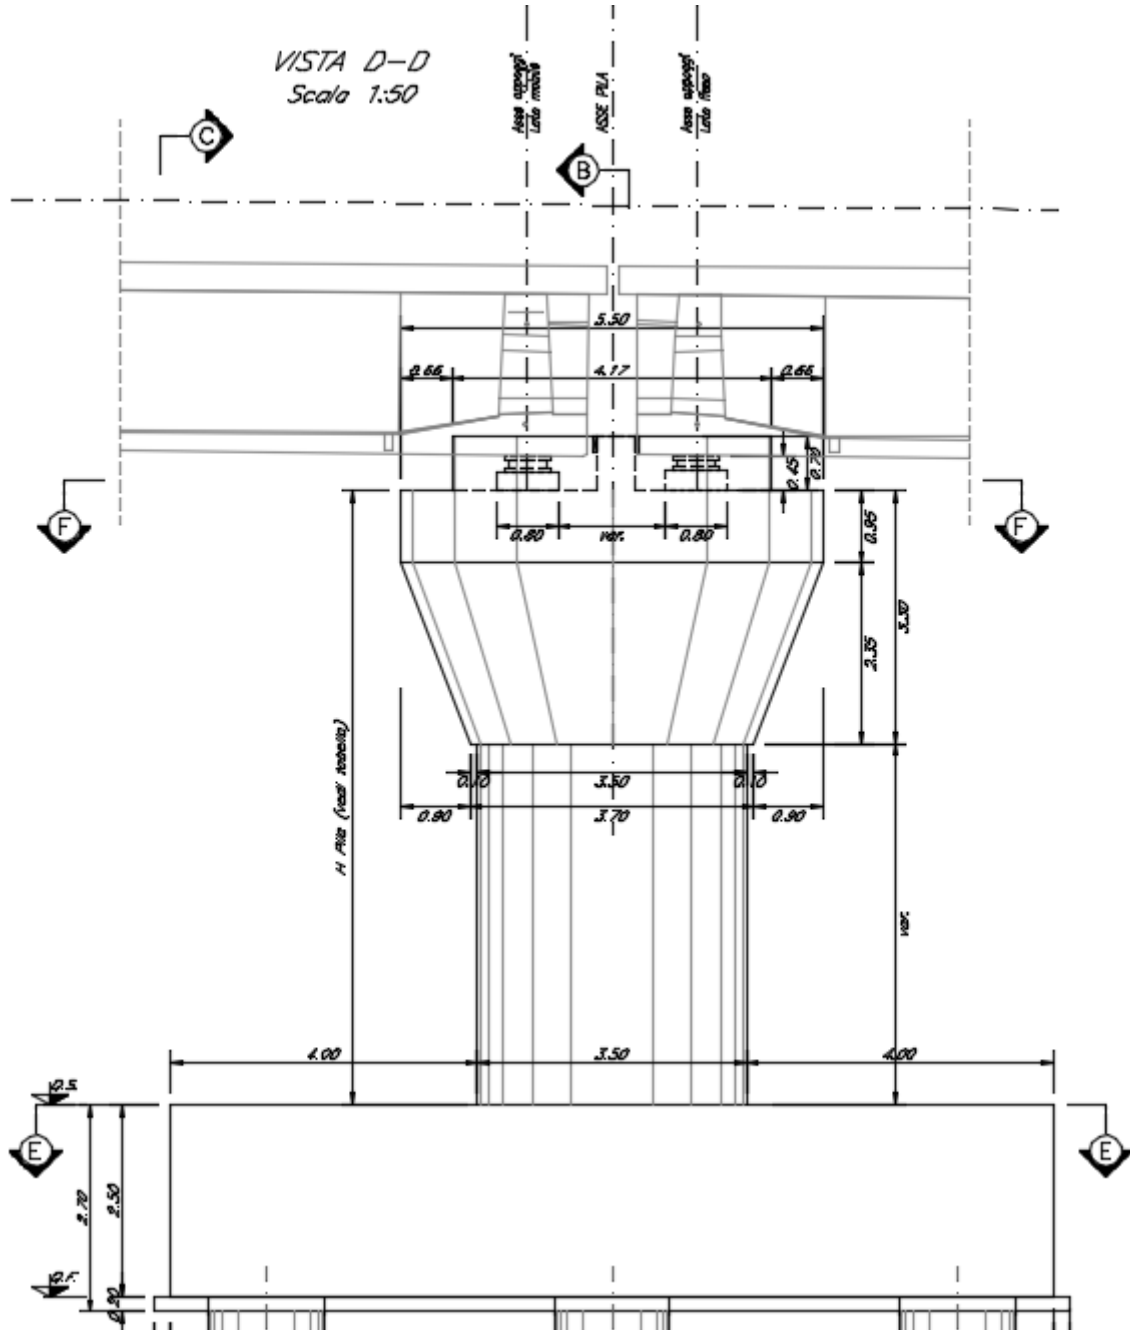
Pila circolare singolo binario – prospetto longitudinale
